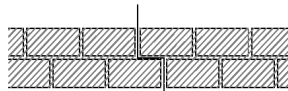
Junta de dilatación con solape. Esquema en planta
